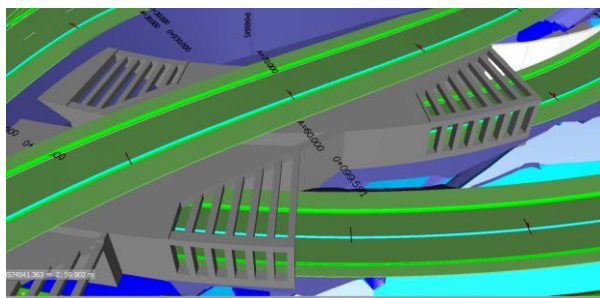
Vista de las estructuras con aligeramientos en losa y hastiales.
